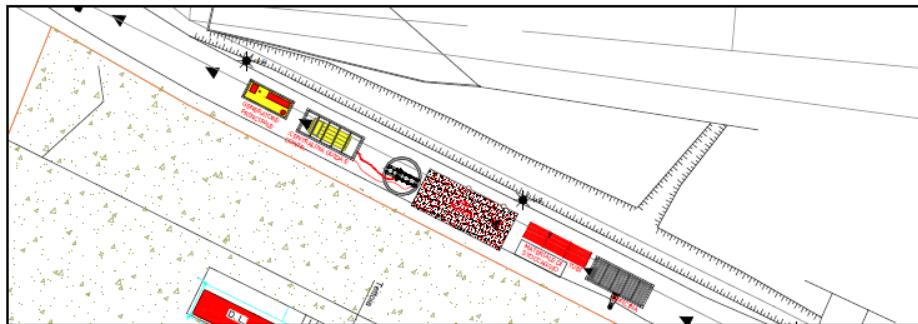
Schema di cantiere Microtunnelling DN 400mm
